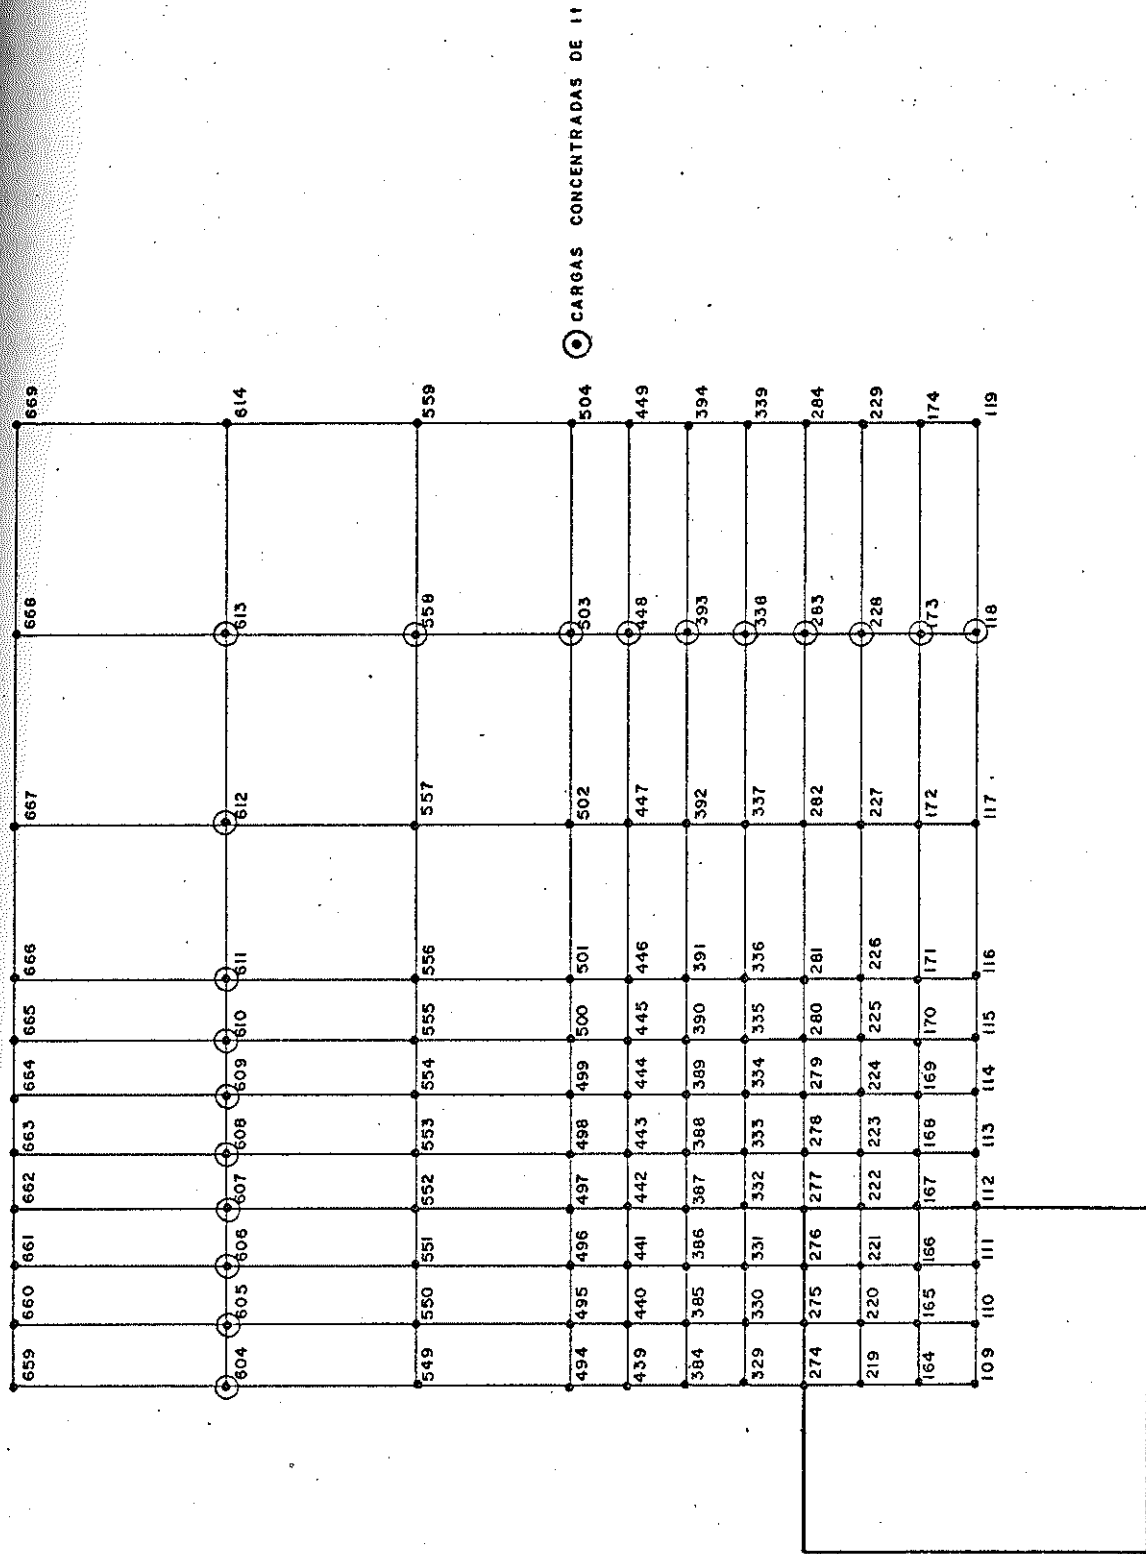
PLANTA - NÍVEL IX (z = 30 cm)
